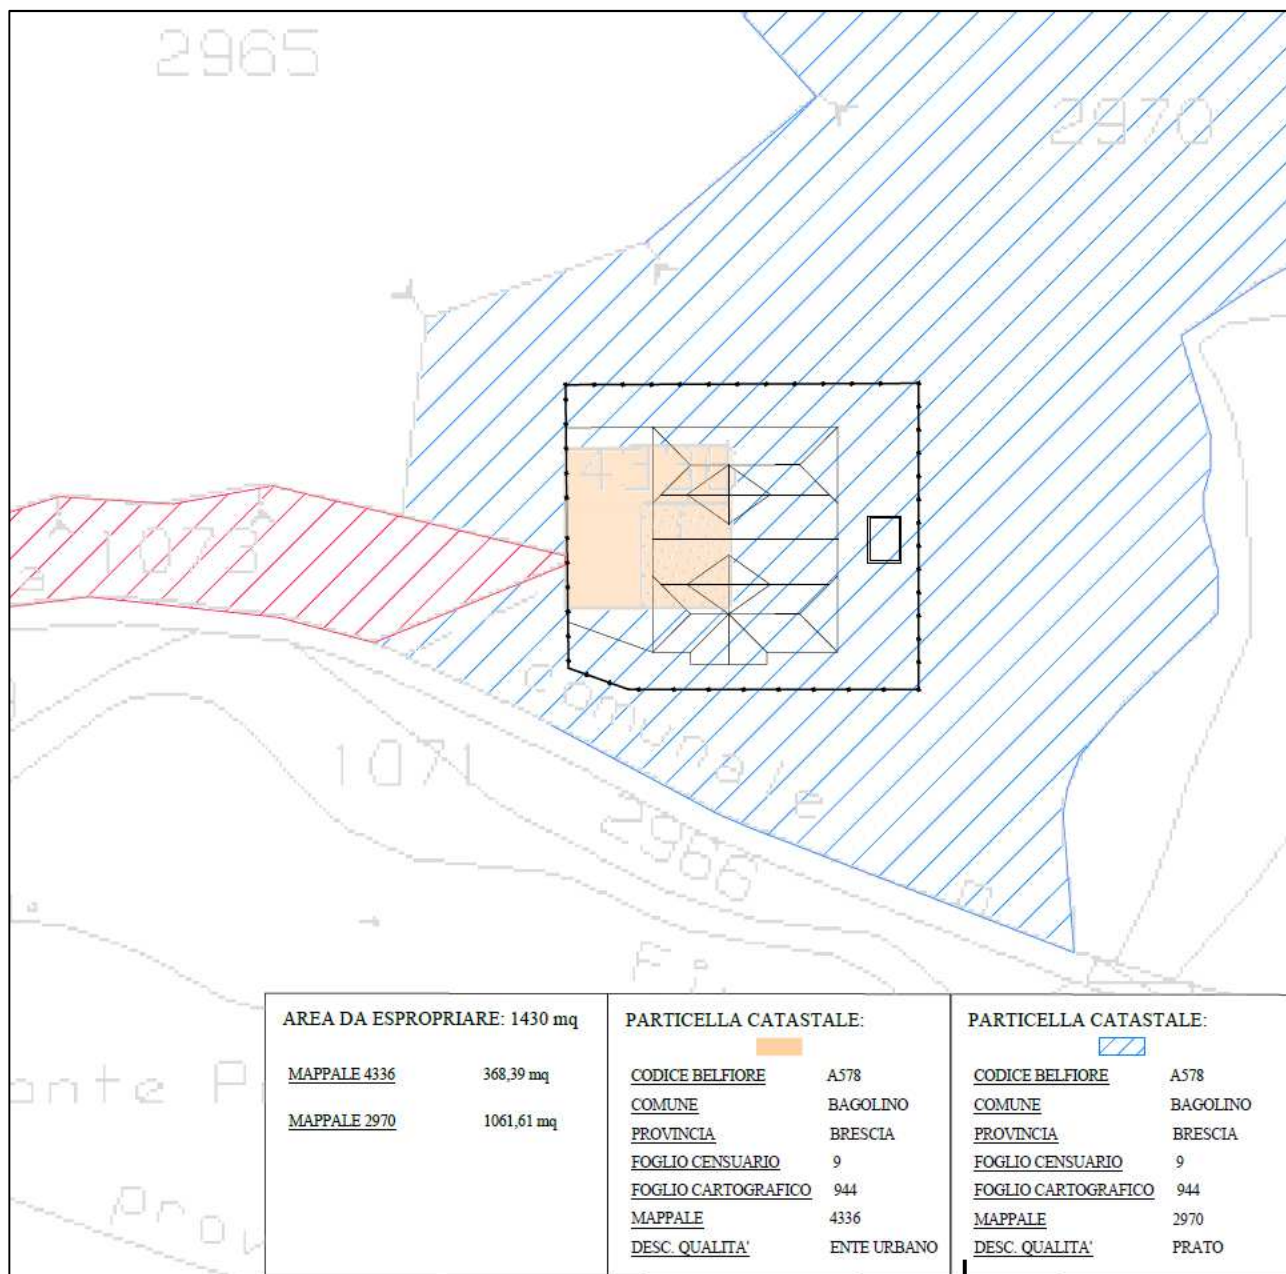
Planimetria catastale Soluzione II B (MBBR)
